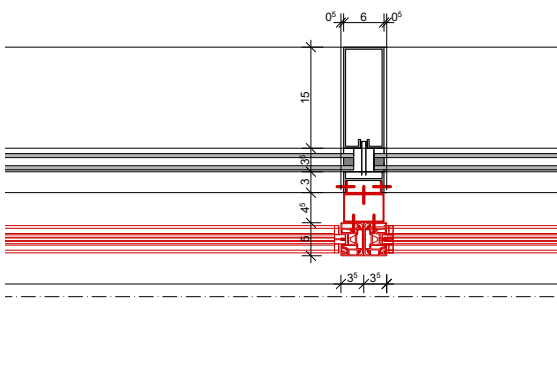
/ Sturz EG Nord-Ost-Fassade Notausgang
